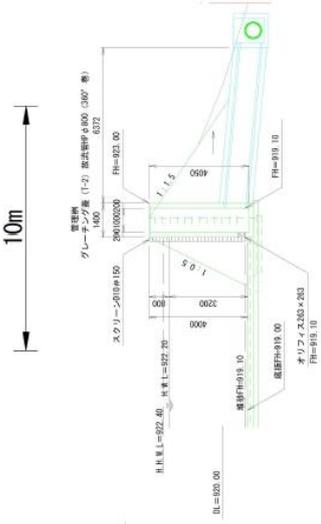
(1) No.1、No.3調整池計画図(平面図)
